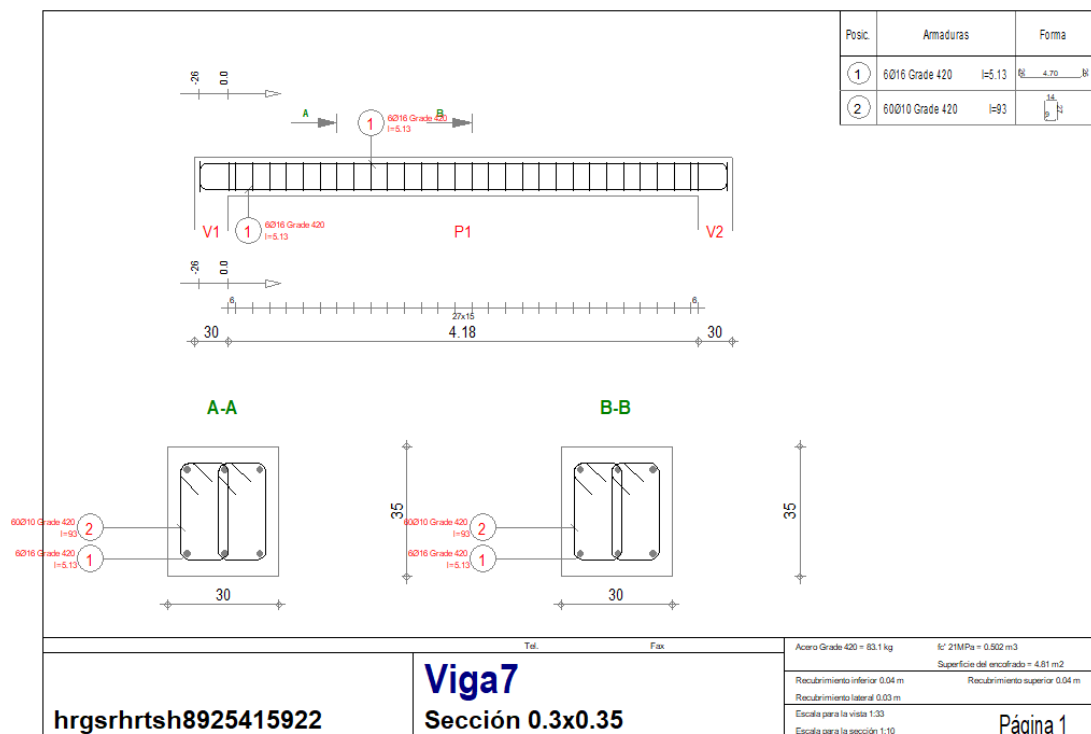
Despiece estructural de la viga 76 de la estructura 3 del Centro Vida.
